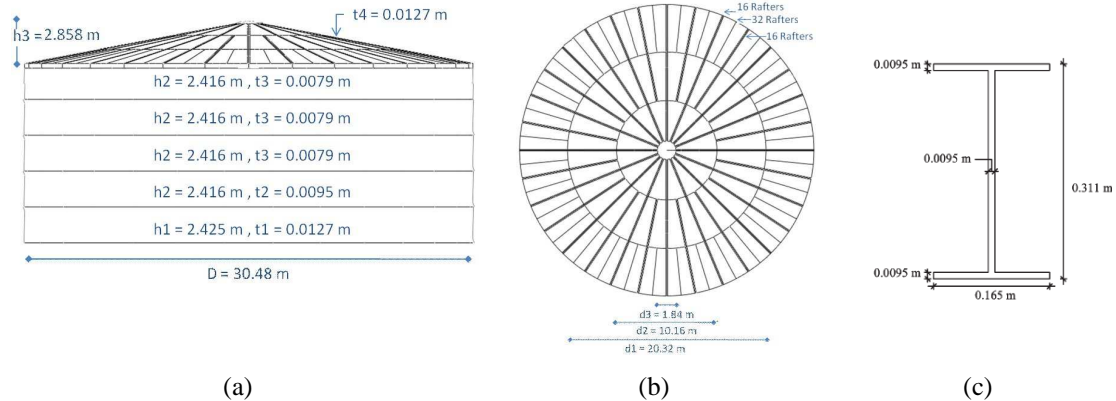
Geometría del tanque con estructura de soporte, (a) Vista frontal, (b) Vista en planta, (c) Vigas adoptadas para estructura de soporte.
